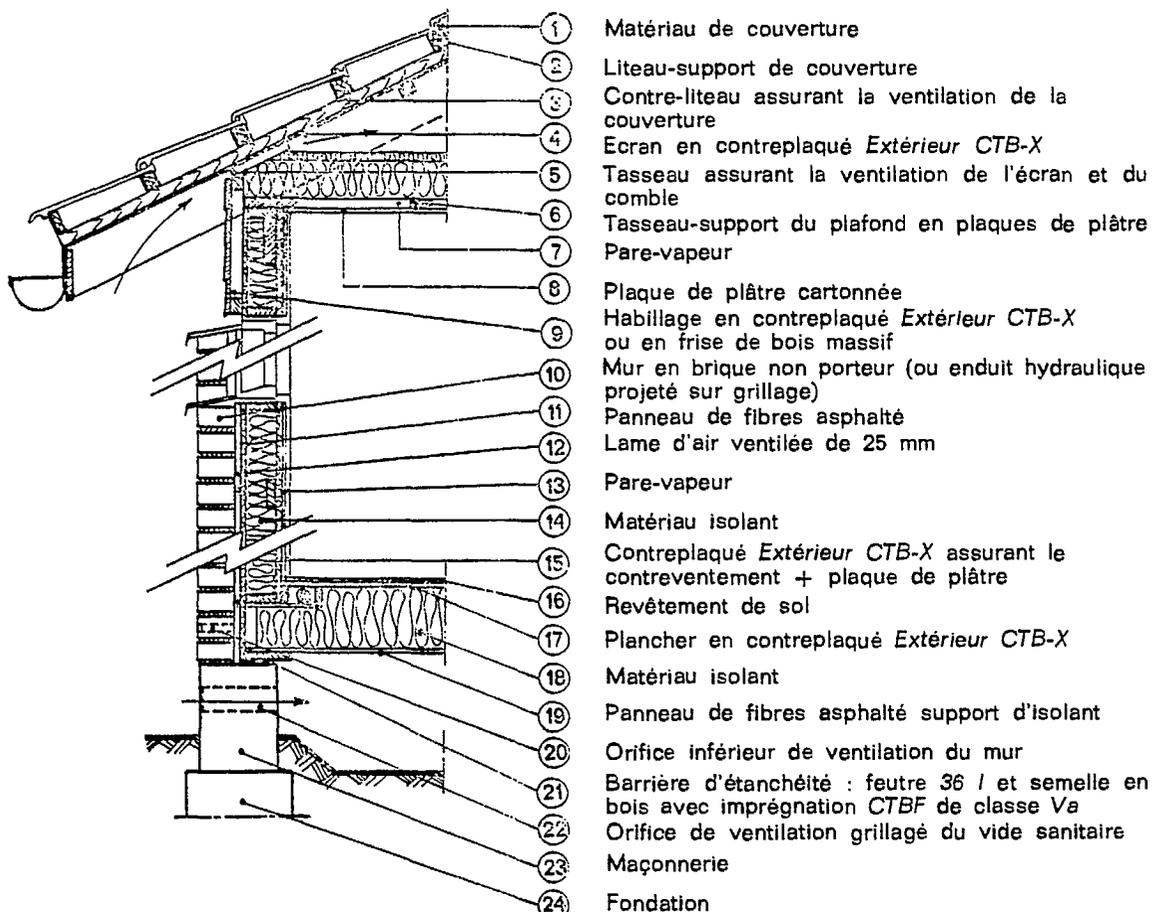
Système classique de maisons traditionnelles à ossature en bois. L'exemple ci-dessus montre une maison à ossature en bois, réalisée en composants d'industrialisation fermée, assemblés sur chantier : paroi-plancher, paroi verticale, paroi-plafond toiture. Une telle maison est élevée et mise hors d'eau en un jour par une équipe de quatre hommes à l'aide d'une grue mobile. Les finitions demandent entre quinze jours et deux mois. Les maisons traditionnelles à ossature en bois ne se distinguent pas extérieurement des autres types de maisons. Elles s'intègrent sans difficulté dans chaque site.
